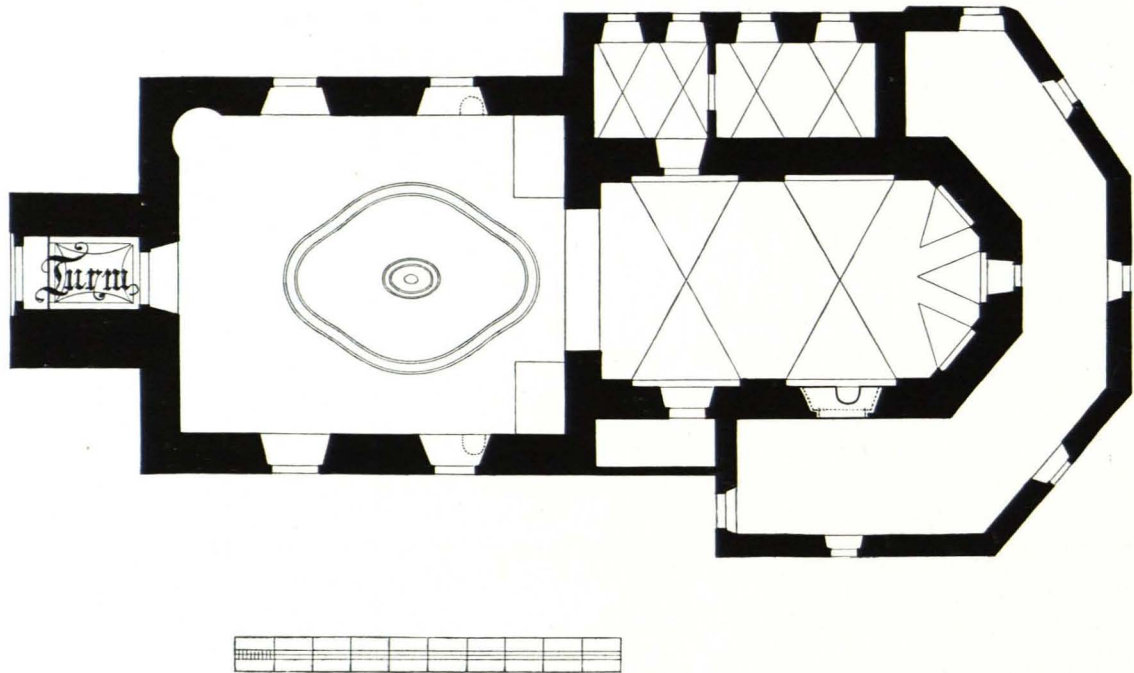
Grainbrunn, Pfarrkirche, Grundriß 1:200 (S. 128)
